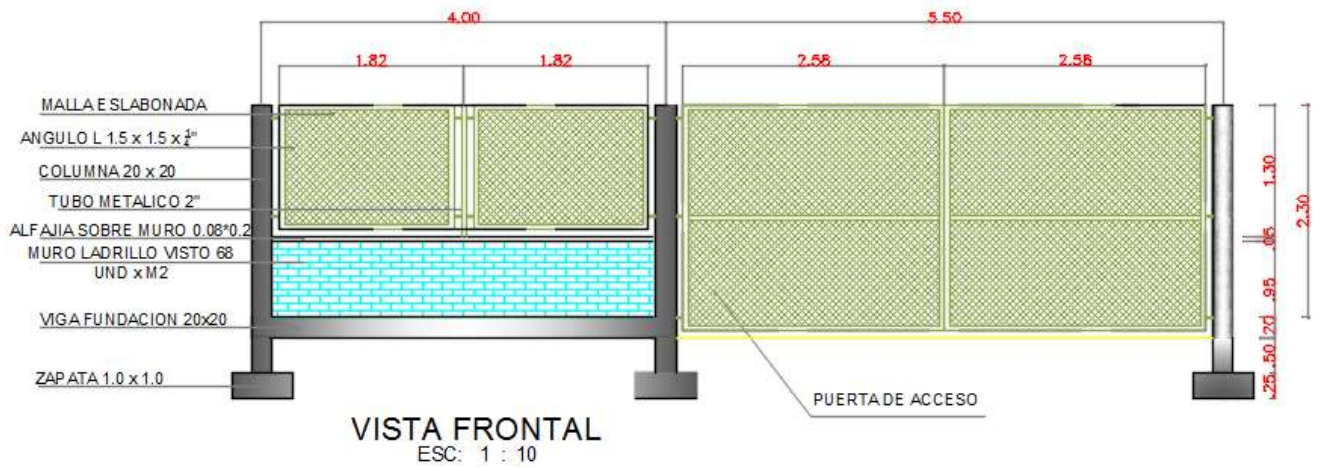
Detalle arquitectónico cerramiento contrato 1302-2015.
